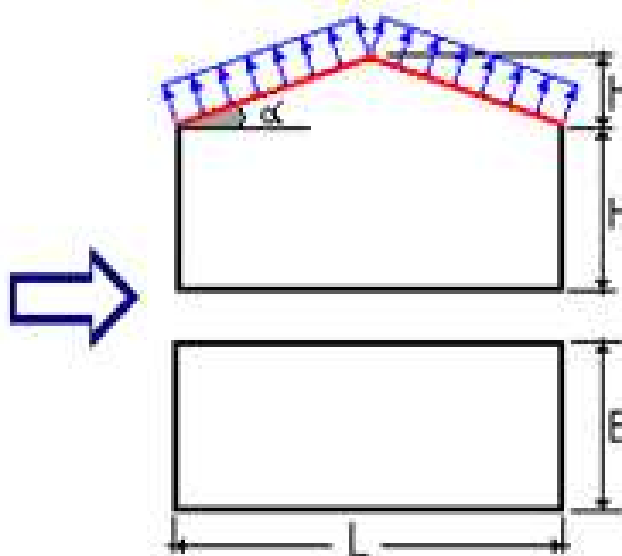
Схема возведения ветровой нагрузки на кровлю
